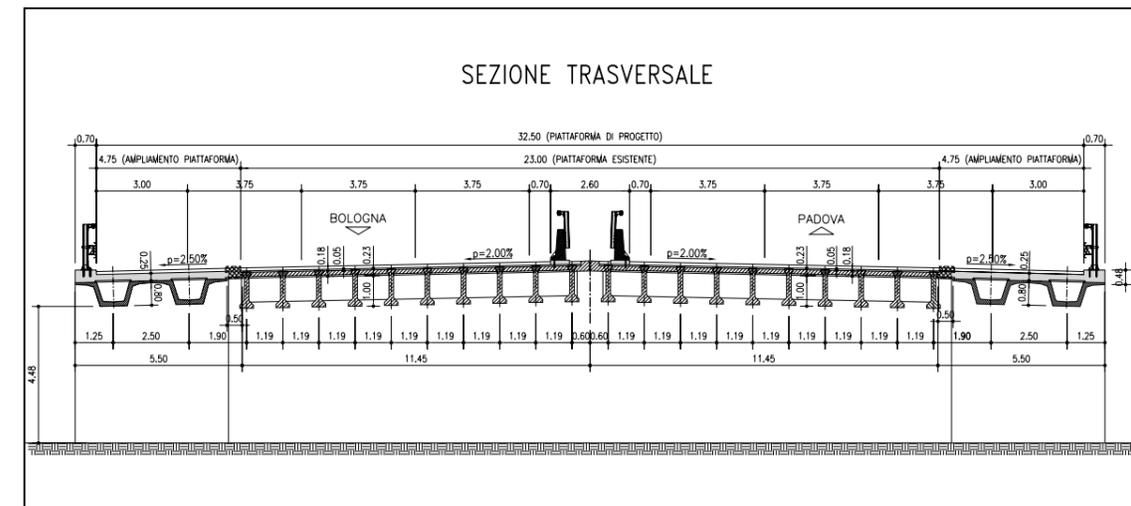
Sezione dell'impalcato e profilo del sottovia della SP 14
